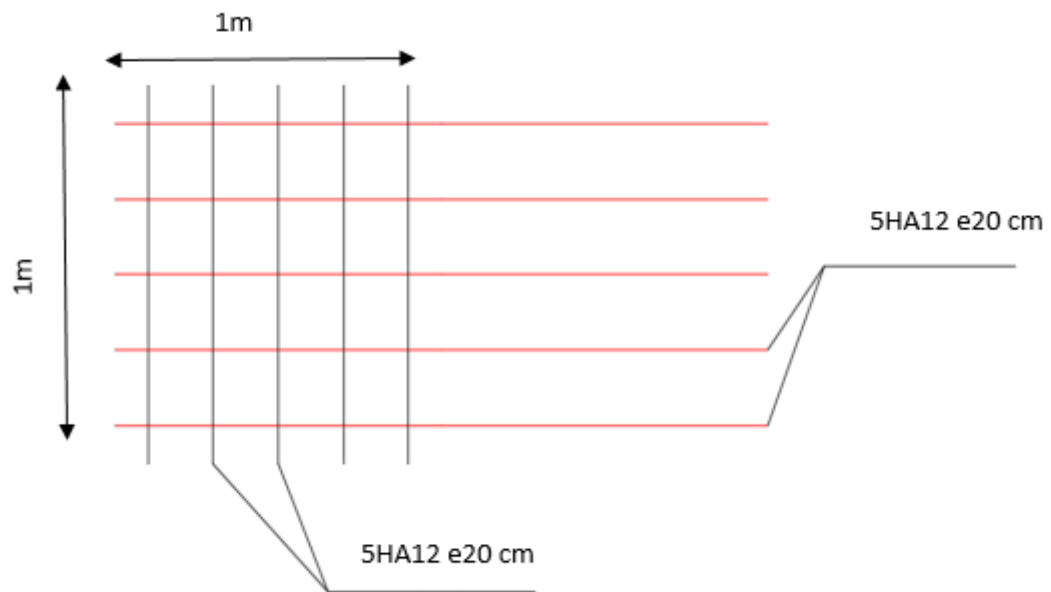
schéma de ferrailage pour une nappe du voile .
